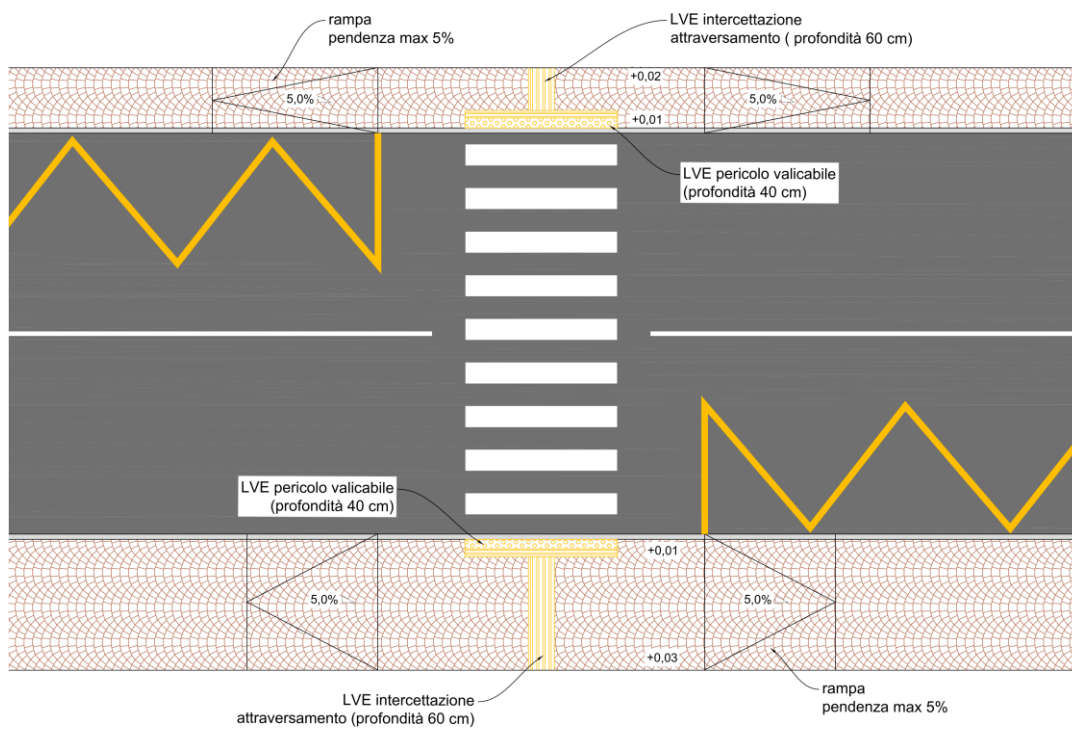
Pianta tipo attraversamento a raso in corrispondenza delle fermate
